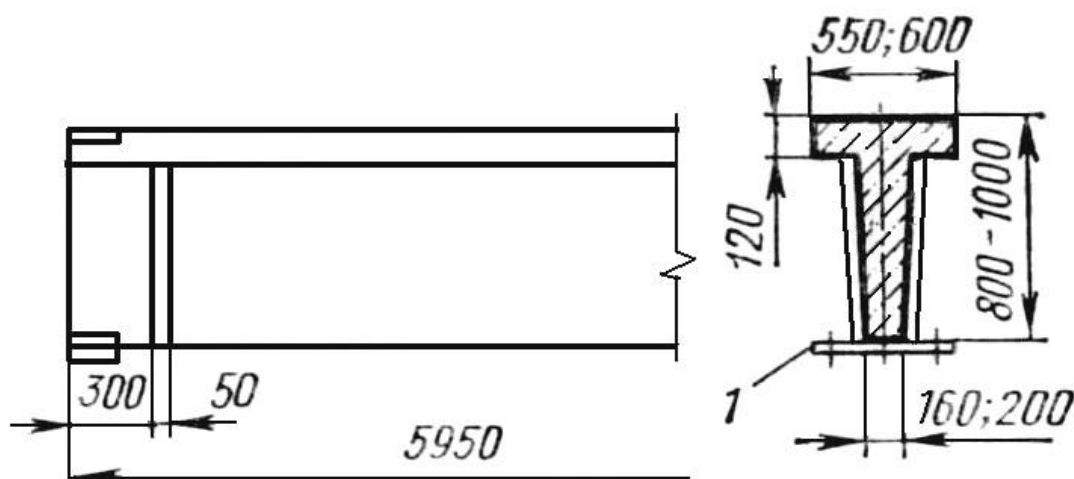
Залізобетонна підкранова балка для кроку колон 6 м
